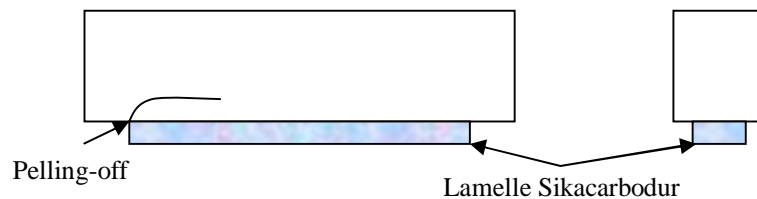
Renforcement poutre par Lamelle Sika Carbodur
